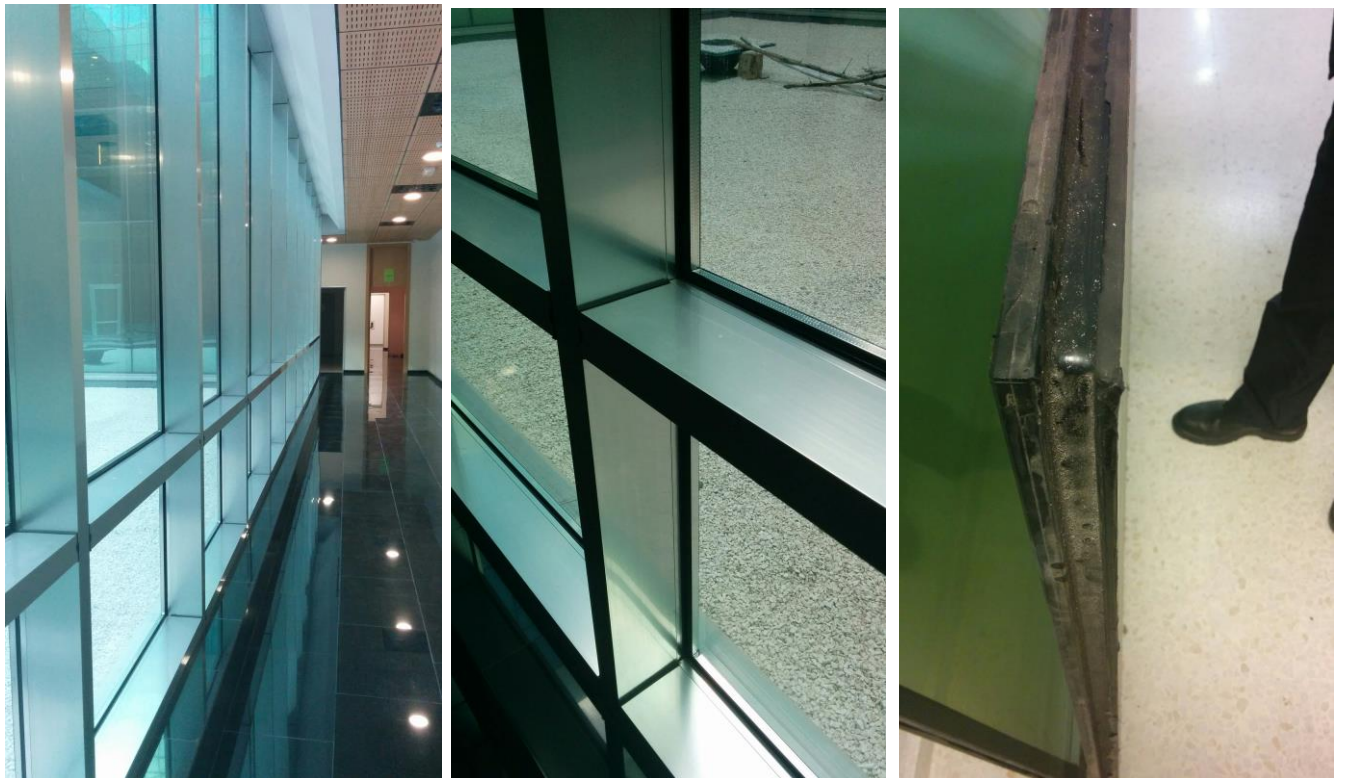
Vistas interior de carpinterías y detalles de carpintería y vidrio.
